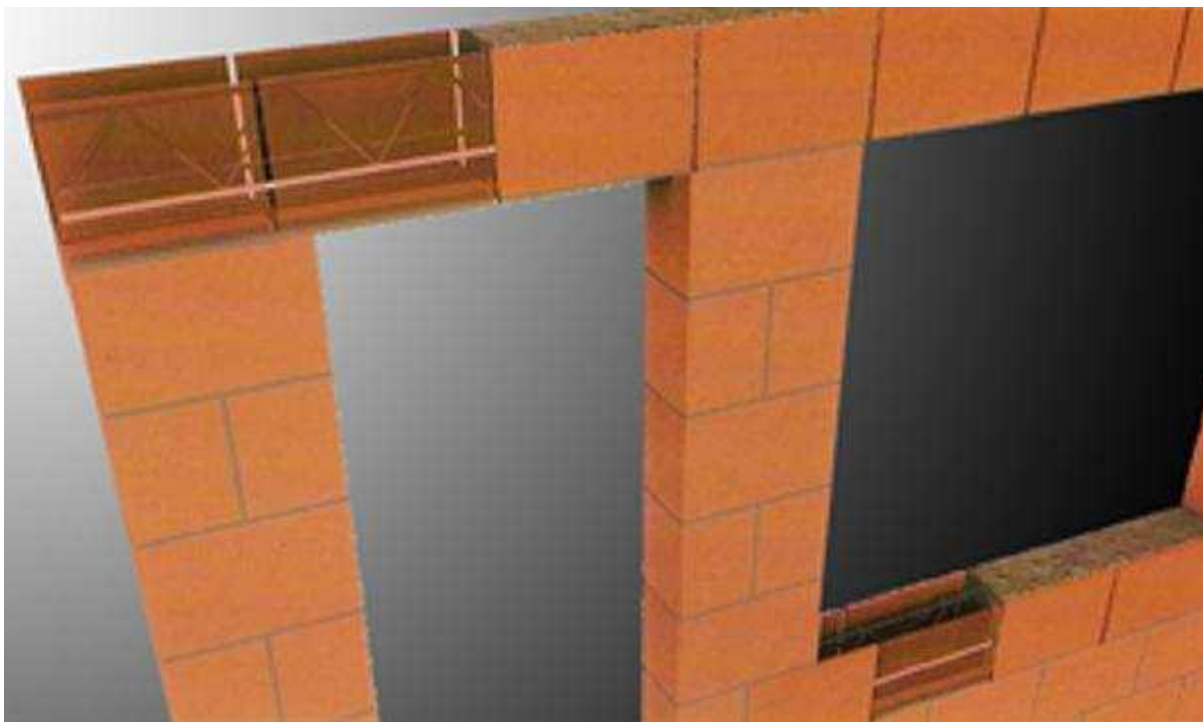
Blocos canaleta e armadura para concretagem de verga e contraverga
